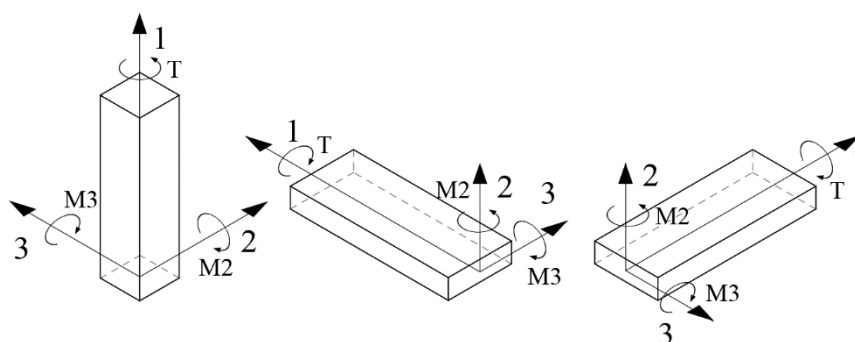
Assi di riferimento per elementi strutturali tipo travi e pilastri
